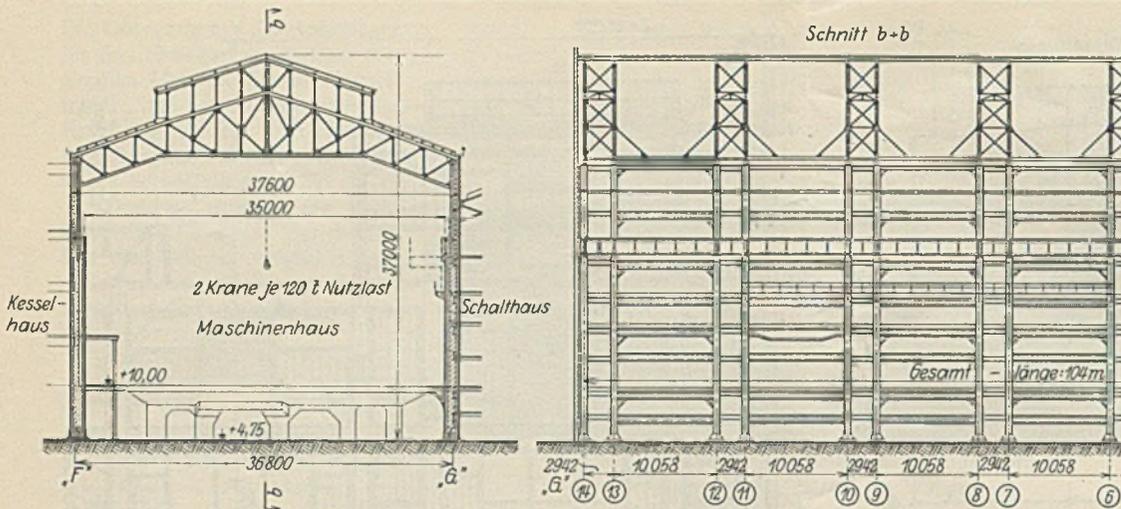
Quer- und Längsschnitt des Maschinenhauses.
